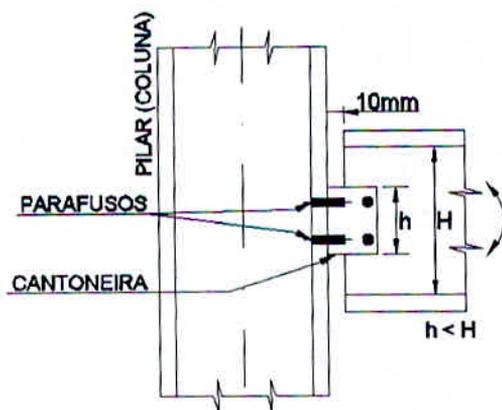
Ligação flexível viga coluna com cantoneira. Fonte: Autor.
